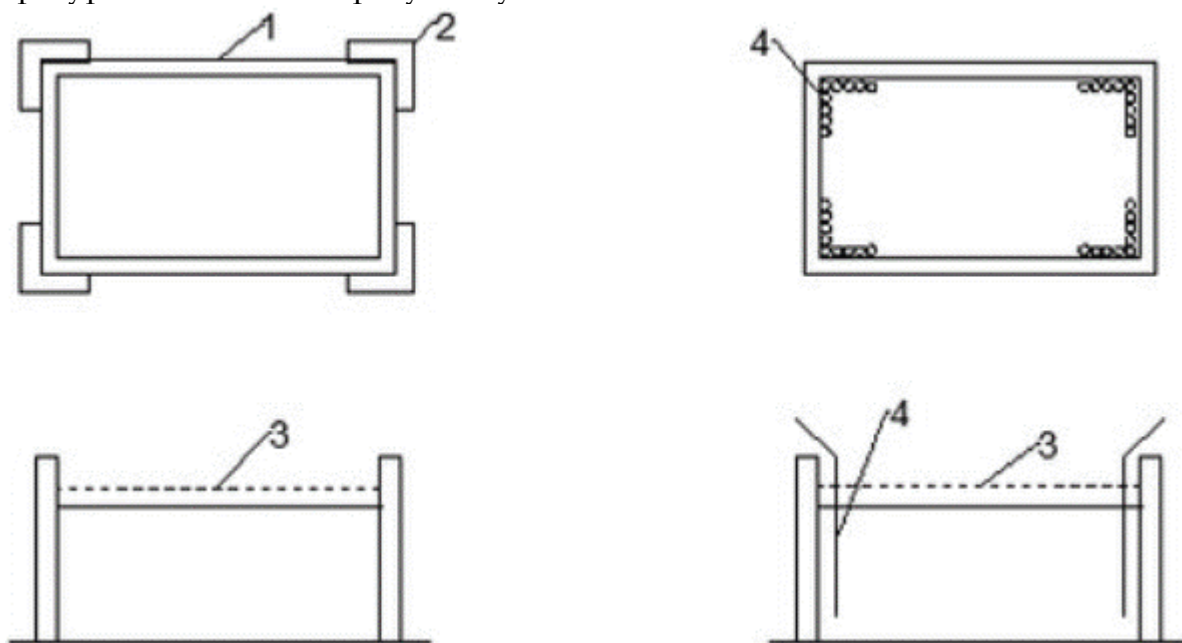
Дополнительные мероприятия по утеплению блоков методом «термоса», а - планы; б - разрезы. 1 - теплая опалубка; 2 - утепление углов; 3 - укрытие; 4 - электрообогрев углов.
